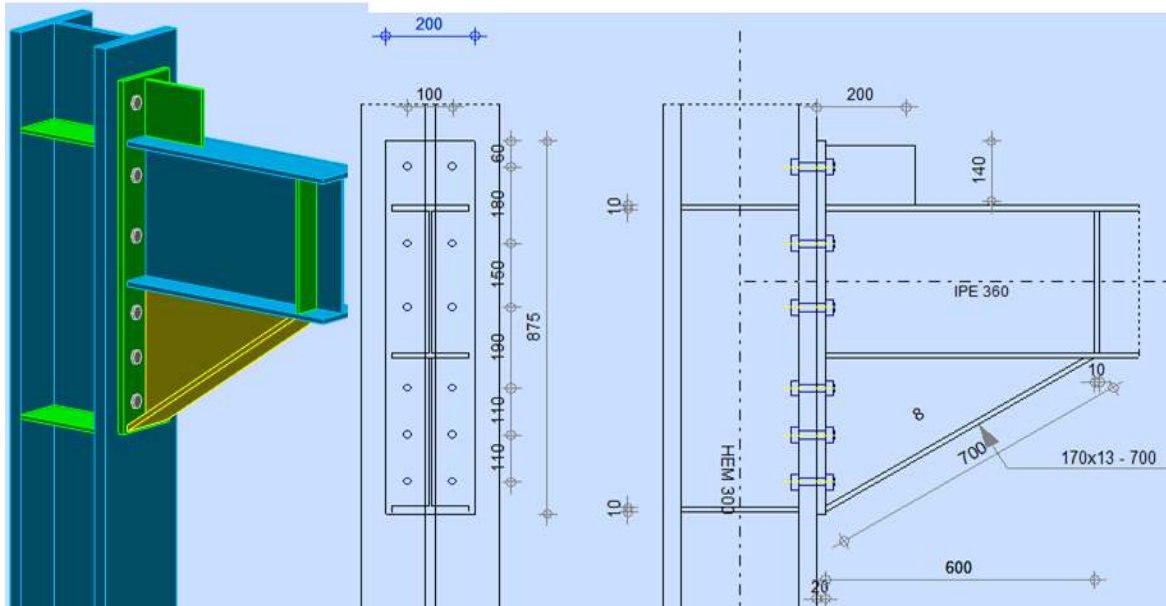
Représentation de l'assemblage poteau HEM 300 – poutre IPE 360
